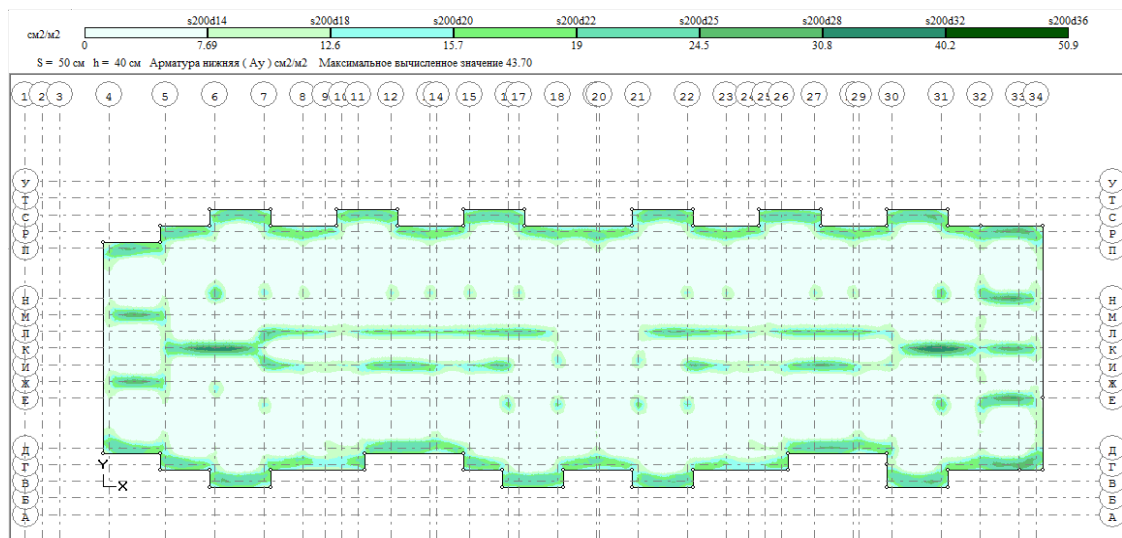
Діаметр і крок нижніх арматурних стержнів уздовж осі «у»
